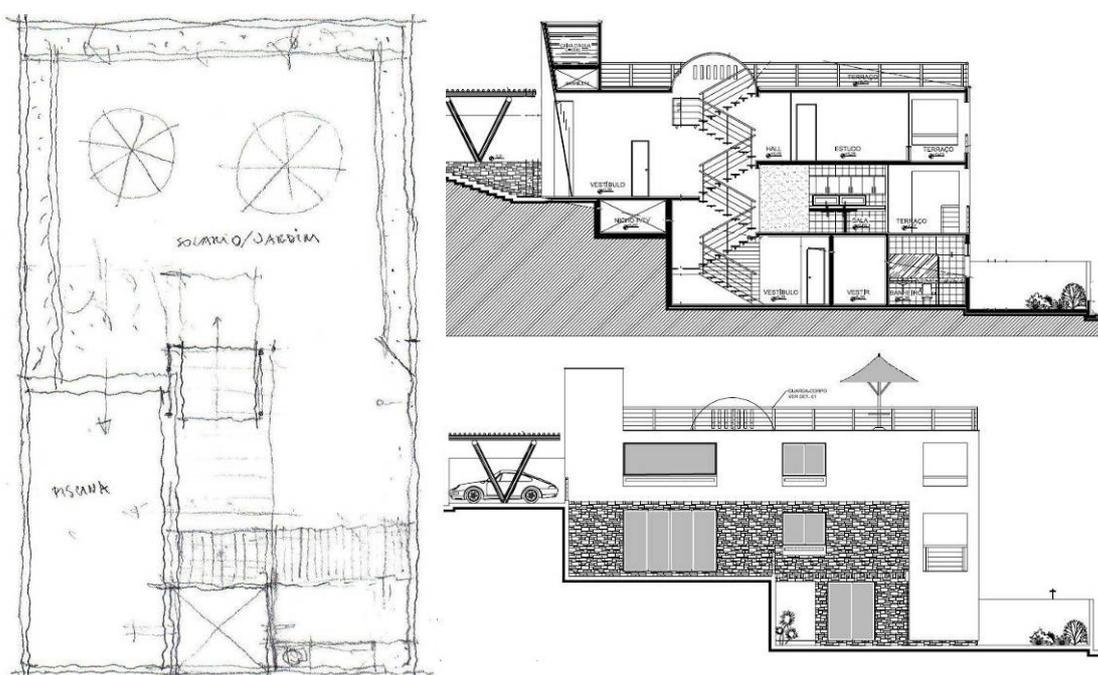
Planta baixa do solário, corte longitudinal e fachada sul
